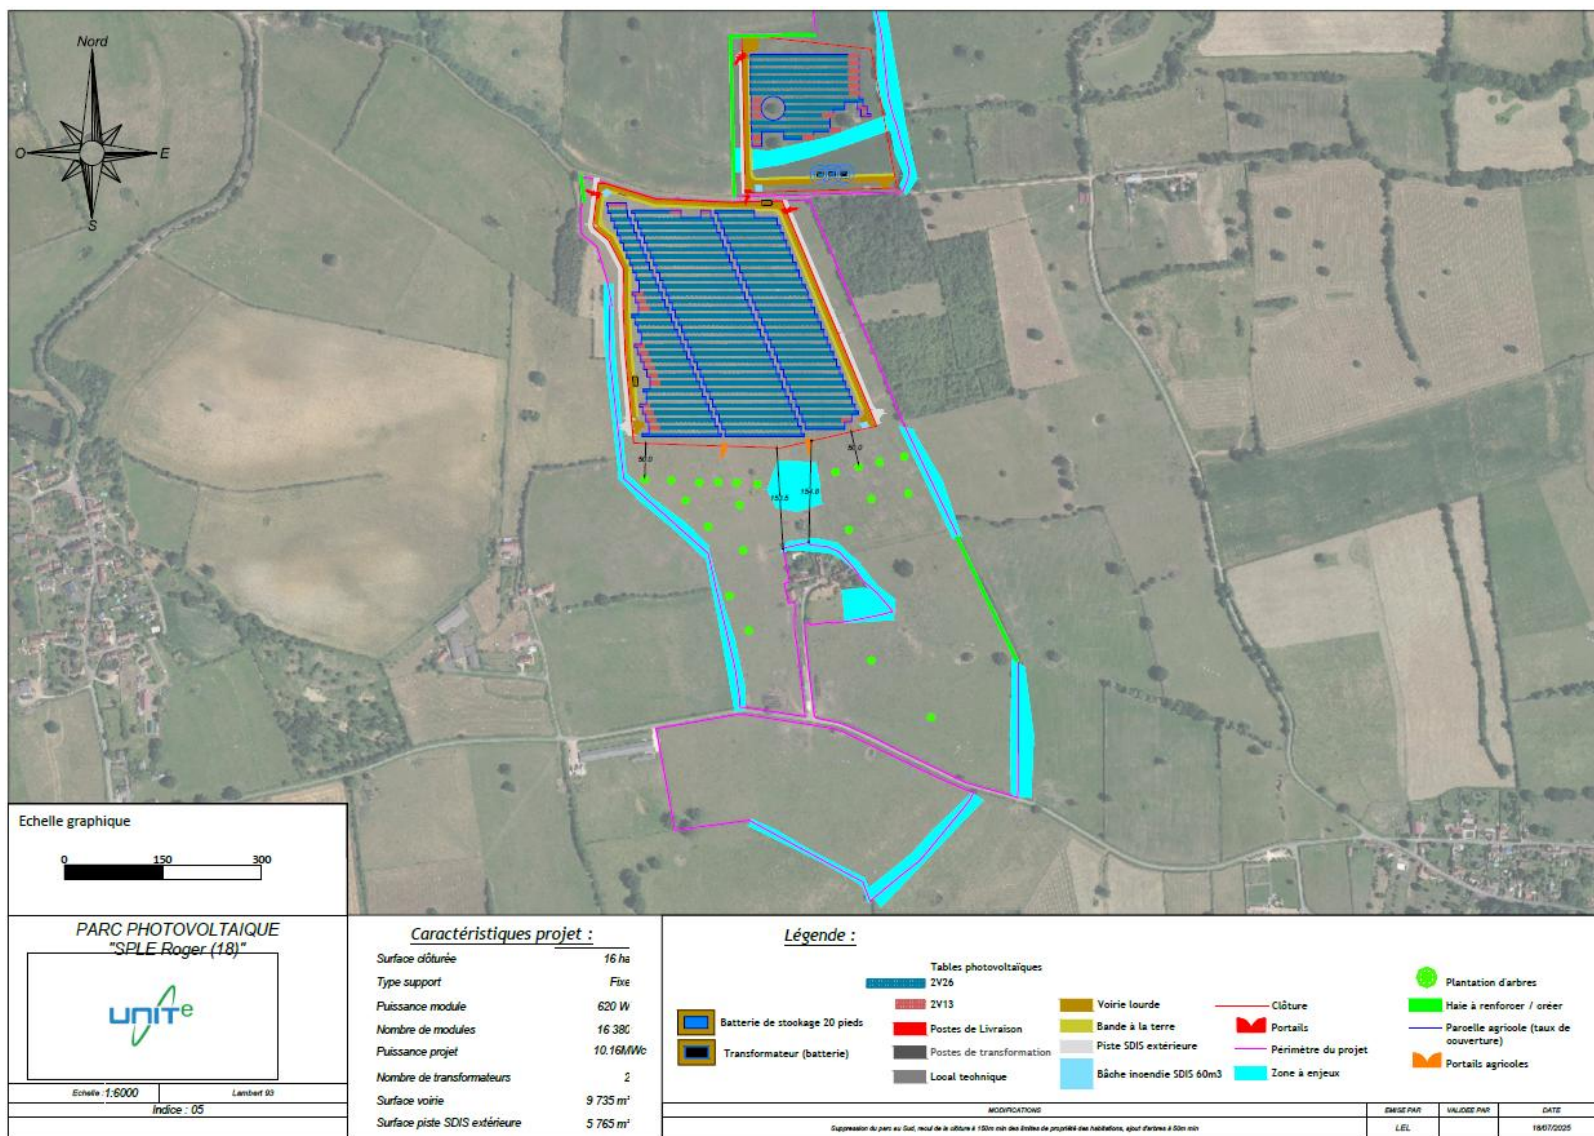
Plan d'implantation des modules photovoltaïques (source : UNITE)
